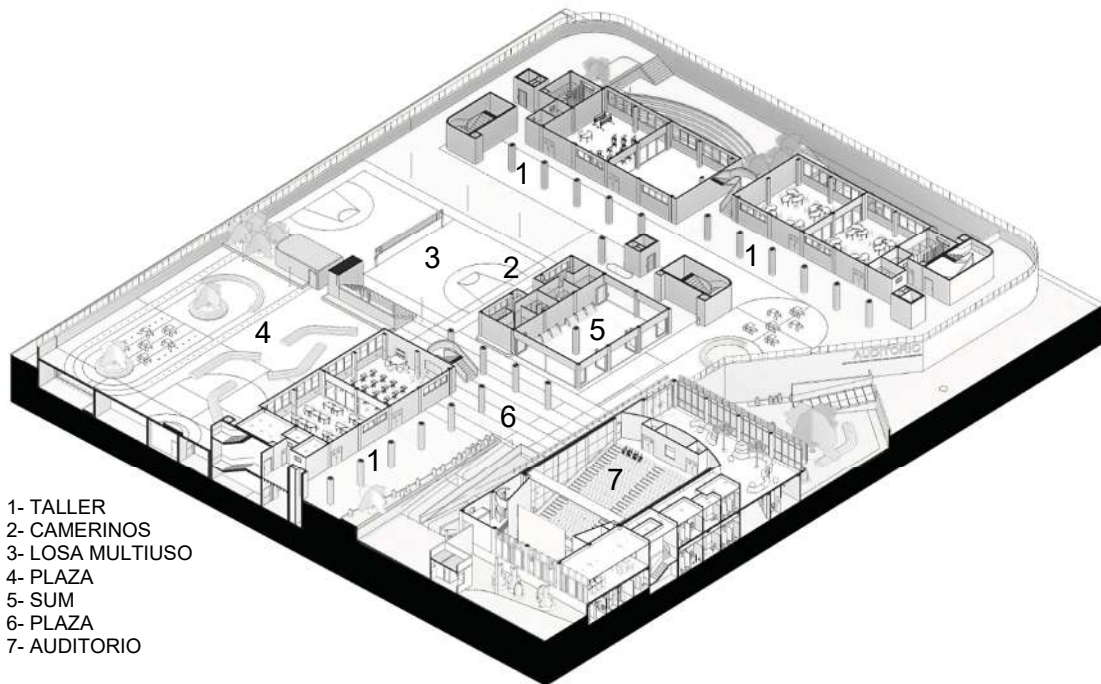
Vista isométrica de planta del primer nivel. - Fuente: Elaboración propia.
